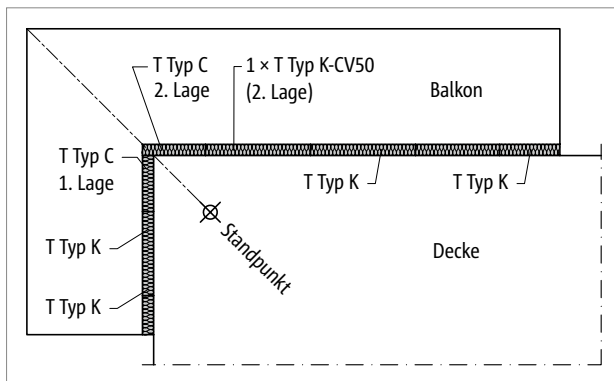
Schöck Isokorb® T Typ C: Balkon mit Außenecke frei auskragend
